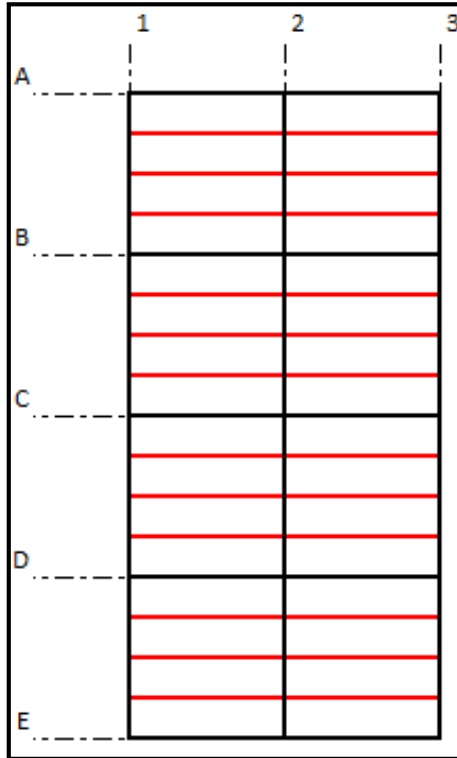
Planta, vigas secundarias con pórticos resistentes a momento.
